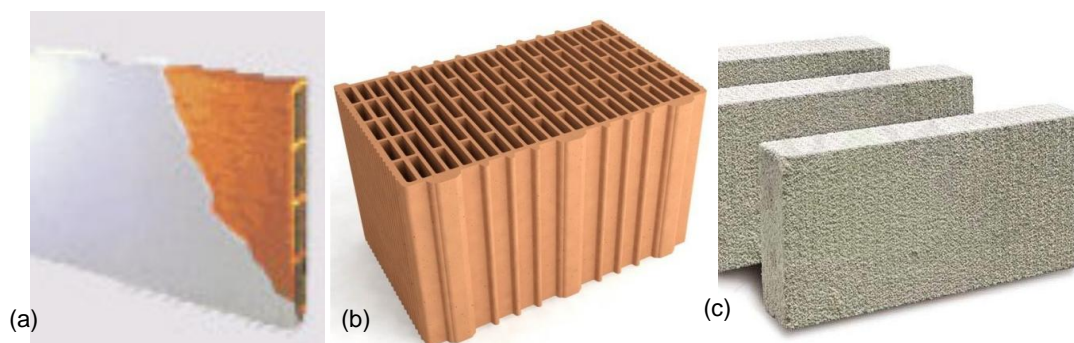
(a) tijolos revestidos a gesso; (b) tijolo cerâmico de furação vertical; (c) betão celular autoclavado.
